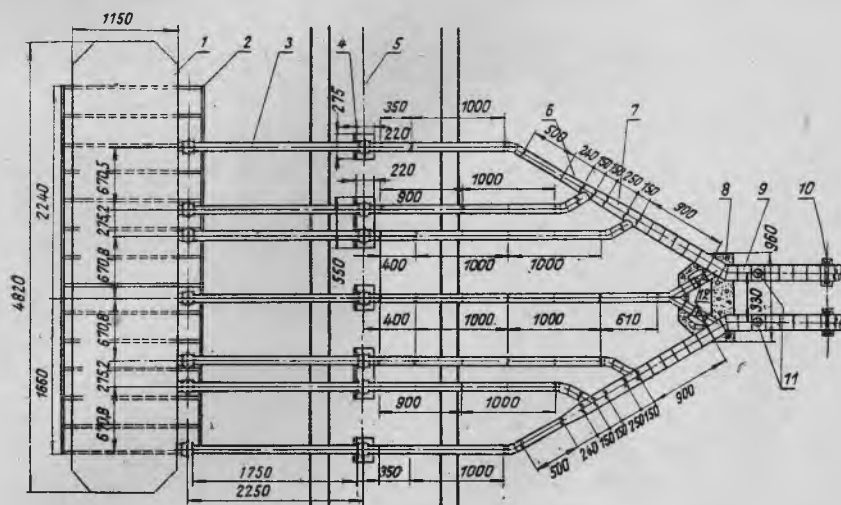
План берегового узла соединений напорных трубопроводов плавучей на-
